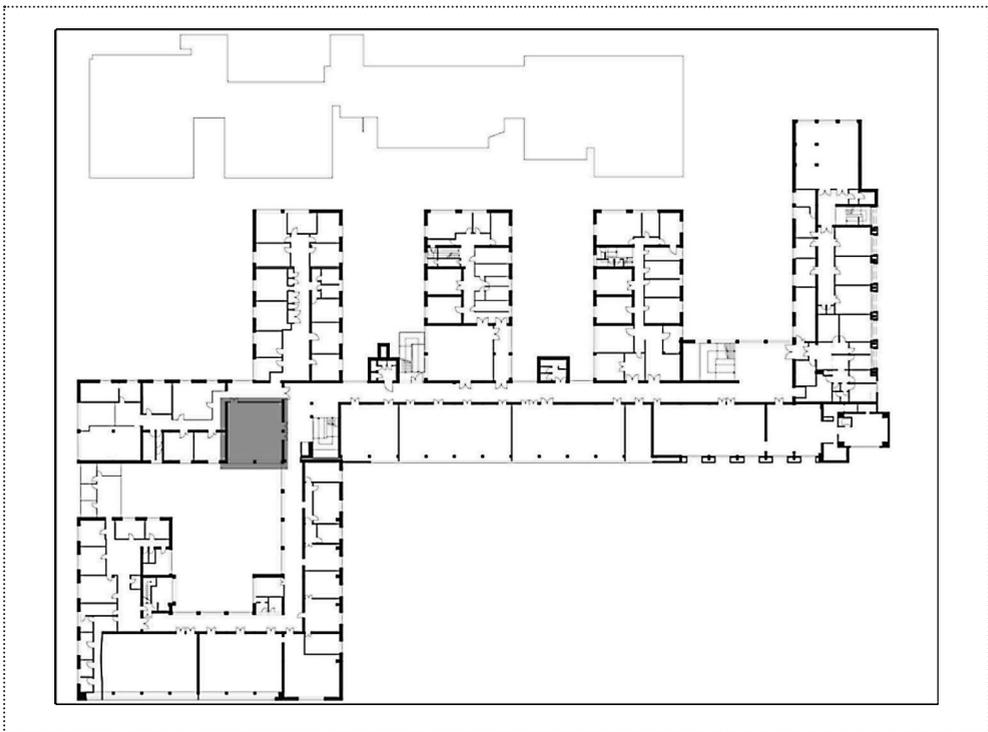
Planimetria con la localizzazione dell'aula oggetto della sperimentazione
